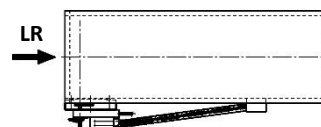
Zuluft, Ausführung Rechts, Draufsicht
